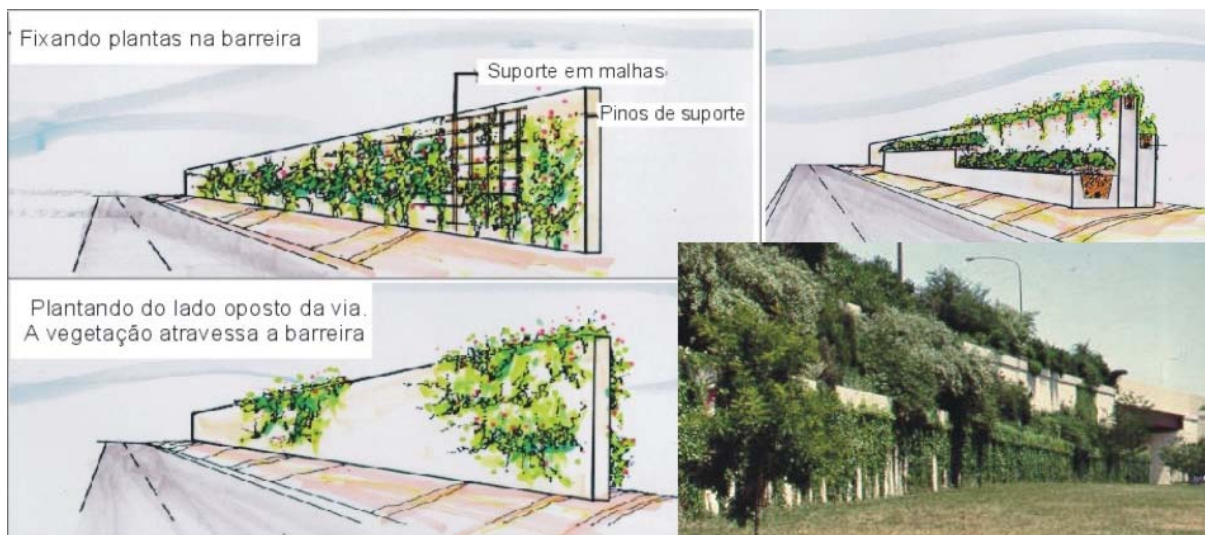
⁵ - Utilização de trepadeiras e escalonamento com jardineiras
